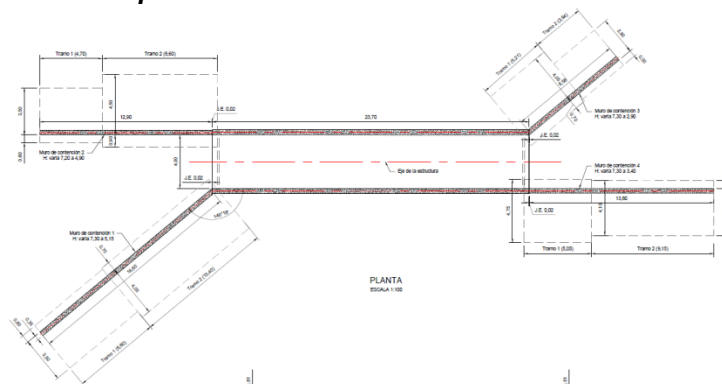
Diseño de Sección Transversal de la estructura de cruce en puente vehicular existente de Envigado
